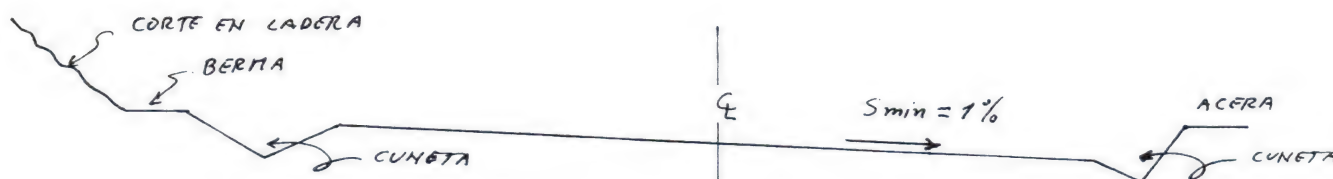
SECCIÓN DE CALLE EN MEDIA LADERA
